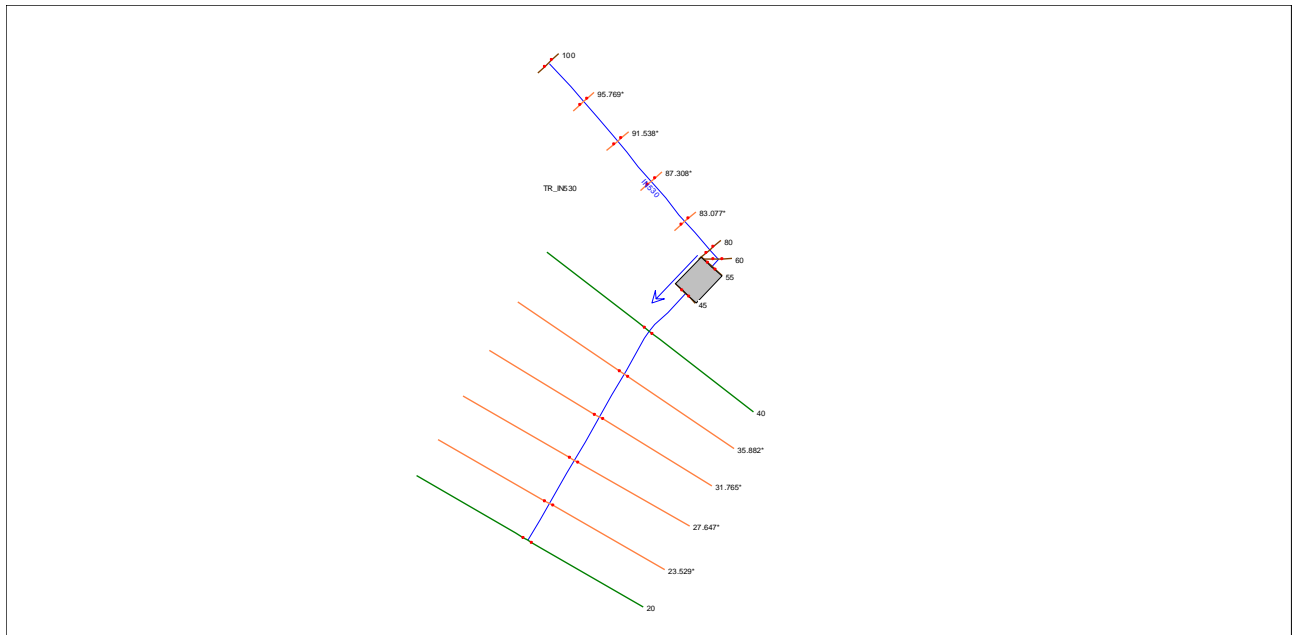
Planimetria modello 1D – stato di progetto interferenza IN530.
